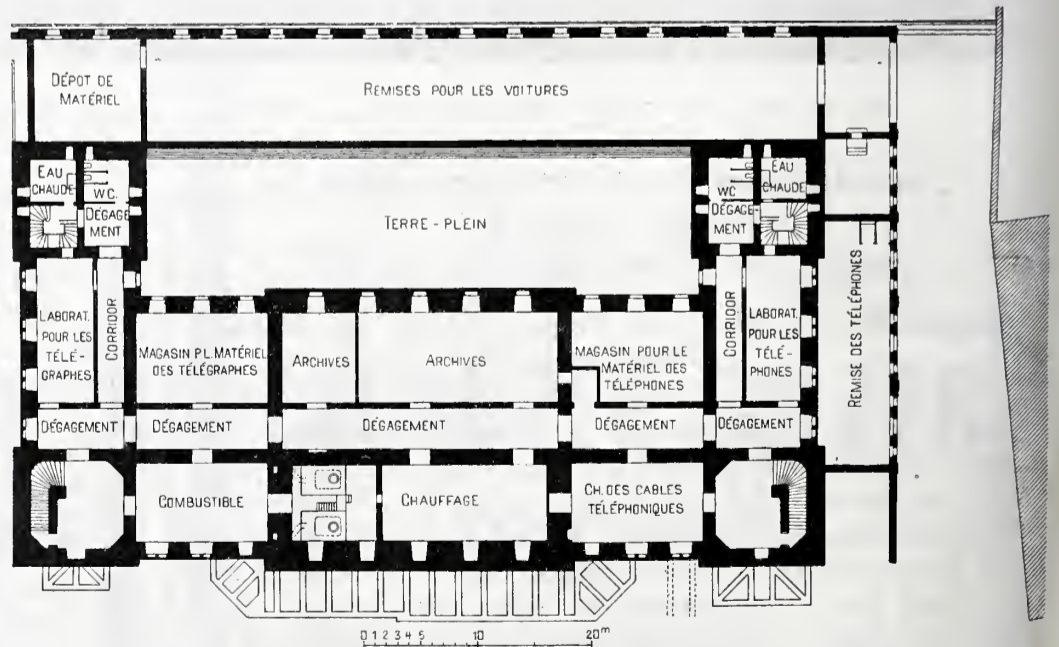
Plan du sous-sol. — Echelle 1 : 800.
